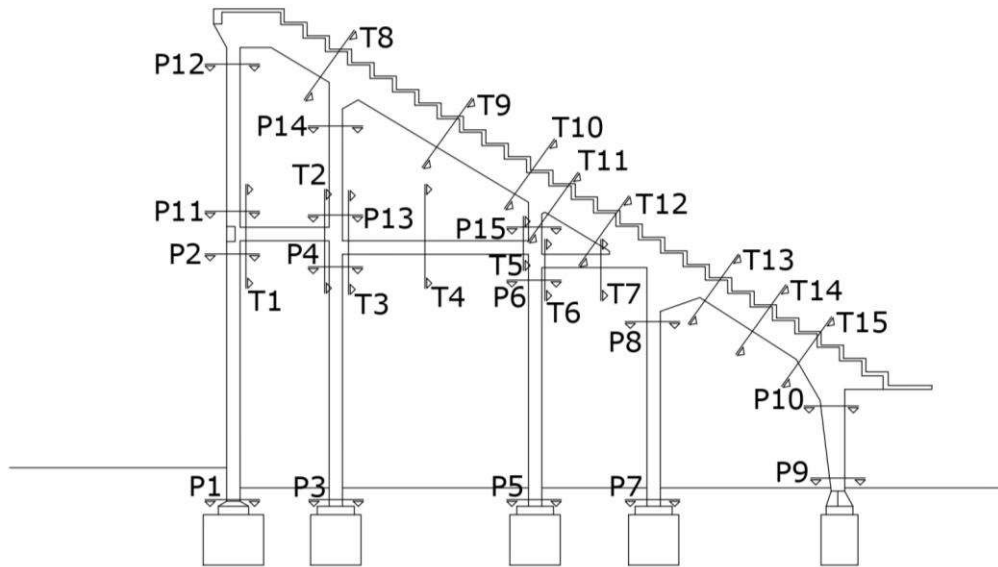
Telaio 4 con indicazione delle sezioni oggetto di verifica
